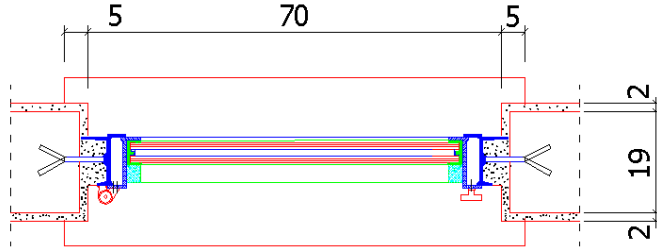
Tek açılırlı PVC pencere planı çizimi
